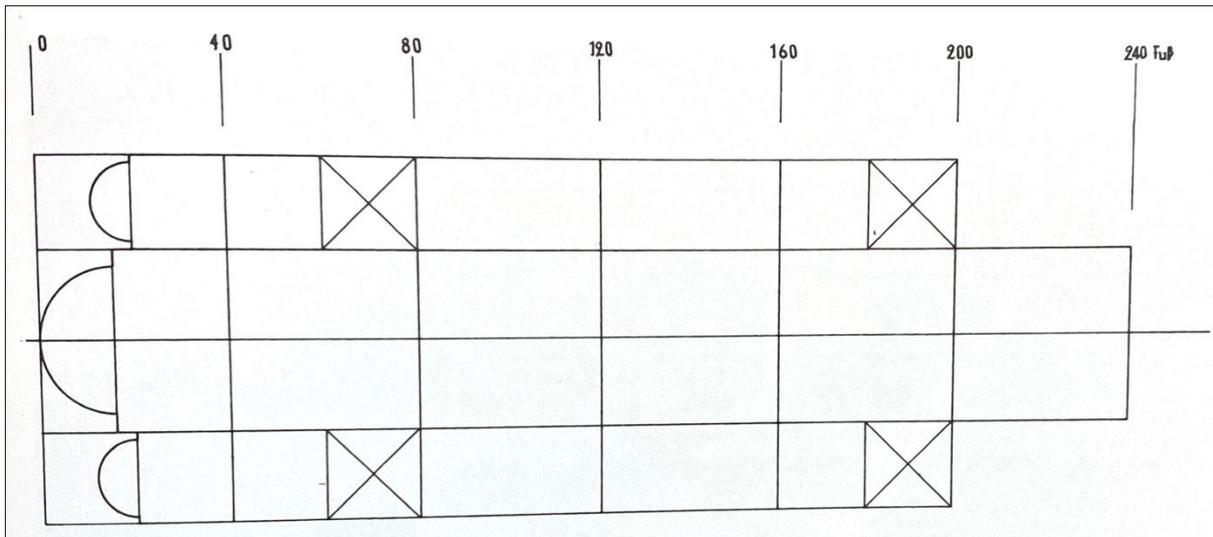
Hans Gelbhaar, Planschema mit 40 Fuß-System.
